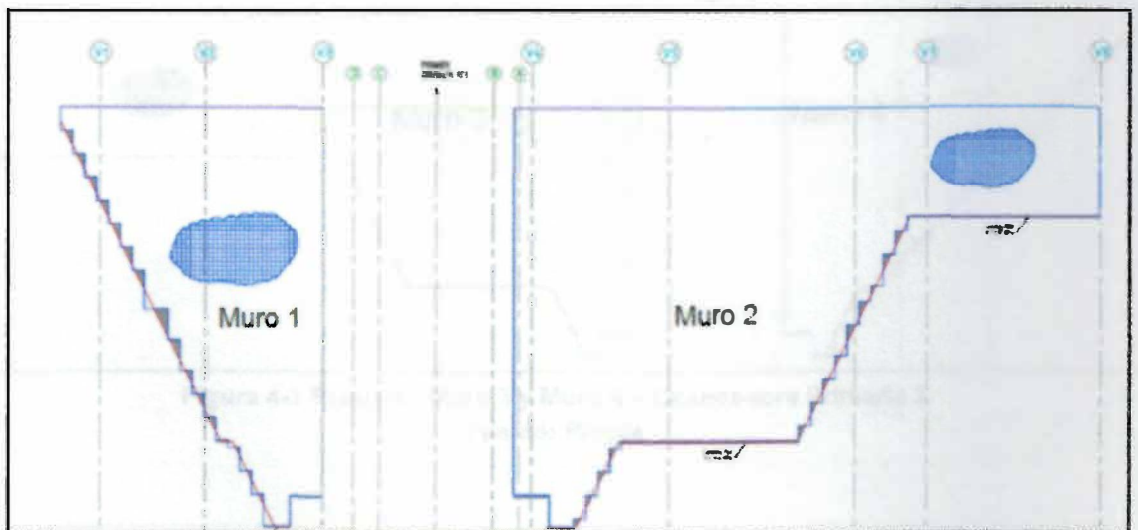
Esquema Muro 1 y Muro 2 – Chancadora Primaria 1
